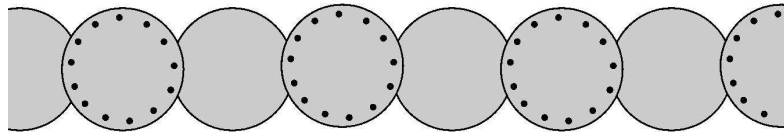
Grundriss überschnittene Bohrpfehlwand
